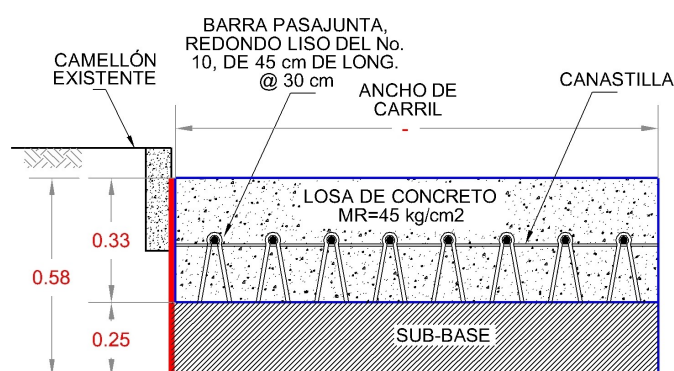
Construcción de losa de concreto hidráulico con juntas
